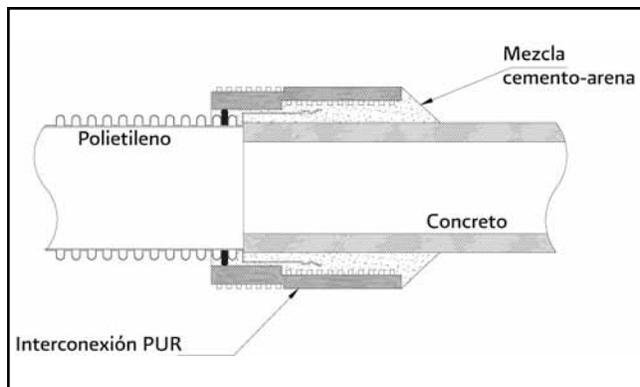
Interconexión de PUR (tubería de plástico y concreto)
